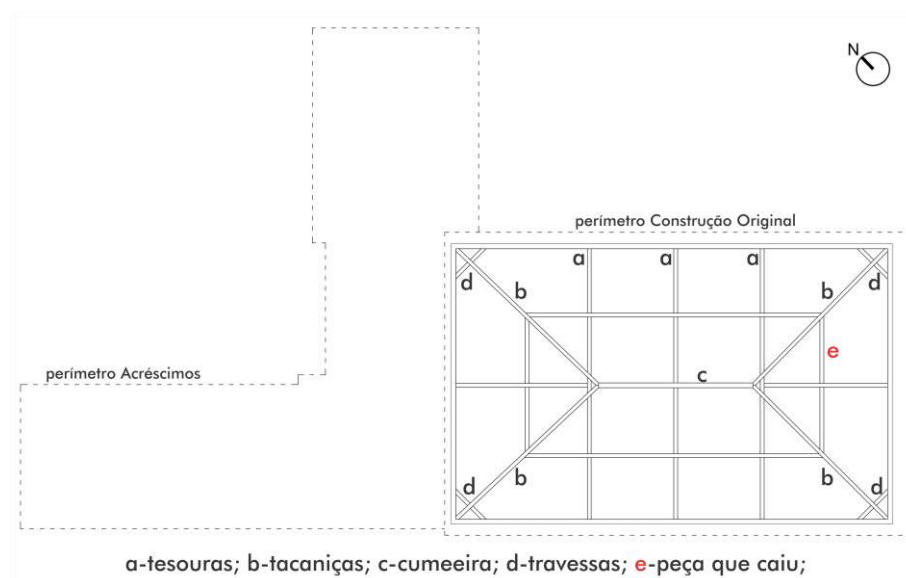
Desenho esquemático estrutura de telhado da *Construção Original* da casa-grande.
